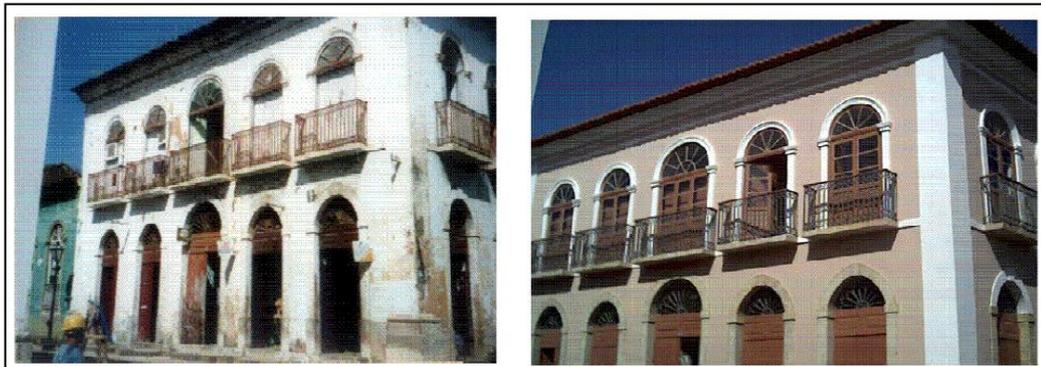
Fachada do imóvel da Rua da Palma, nº 336.
